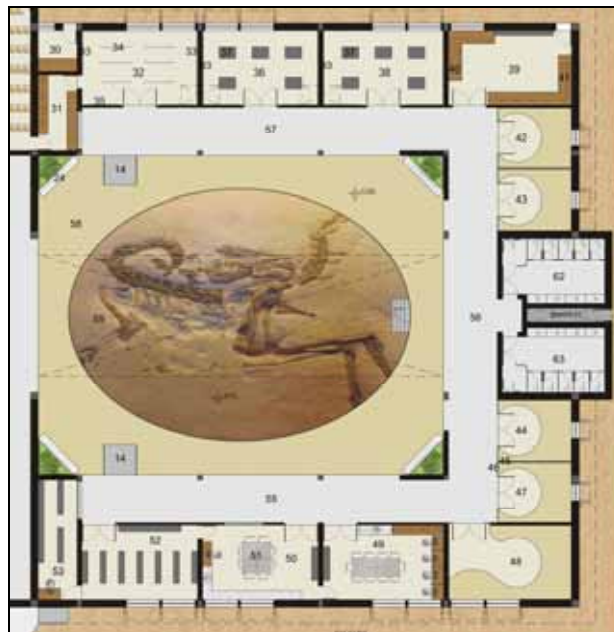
Planta Baixa do lado direito do museu de paleontologia
